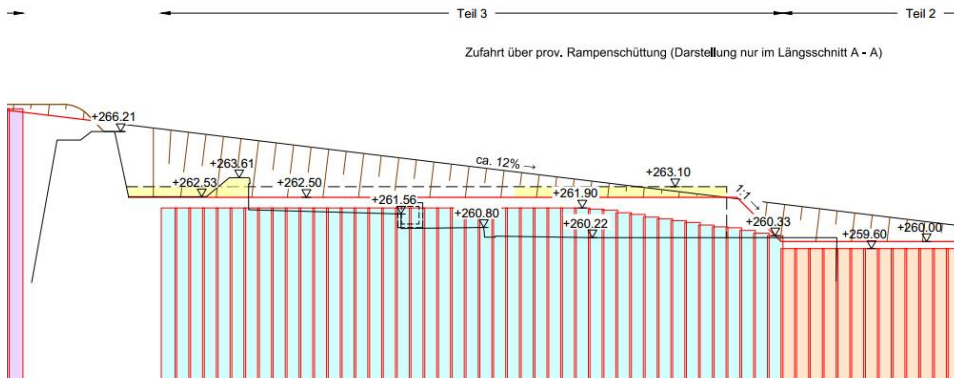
Auszug Schnitt A-A aus dem Plan „Situation Bauetappe 1“, Plan-Nr.1010-021-018
